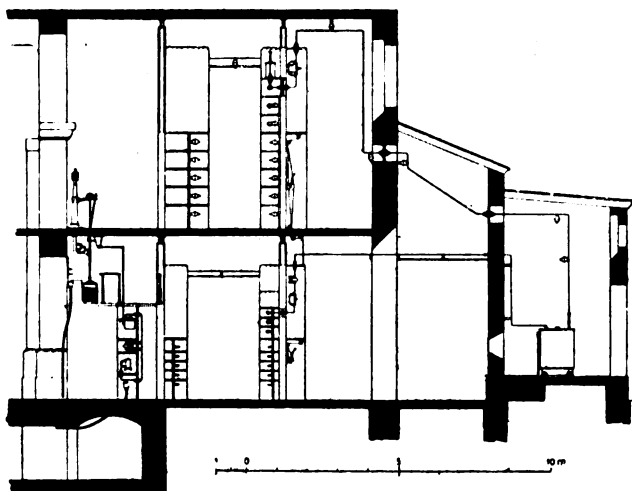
Coupe transversale de l'usine génératrice d'Obermatt. Échelle : 1/250.
